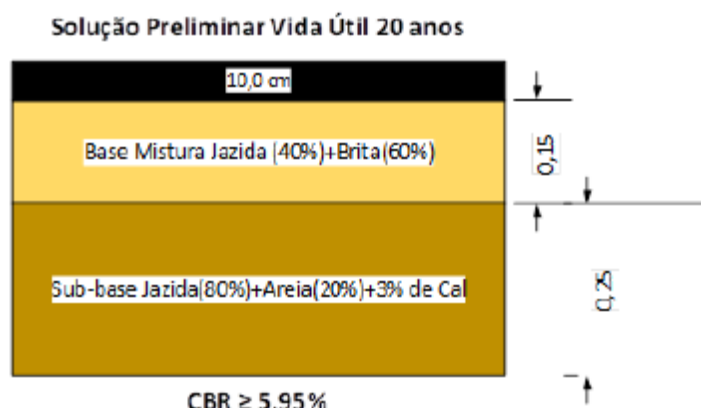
Seção Típica Pavimento Vida Útil 20 anos
